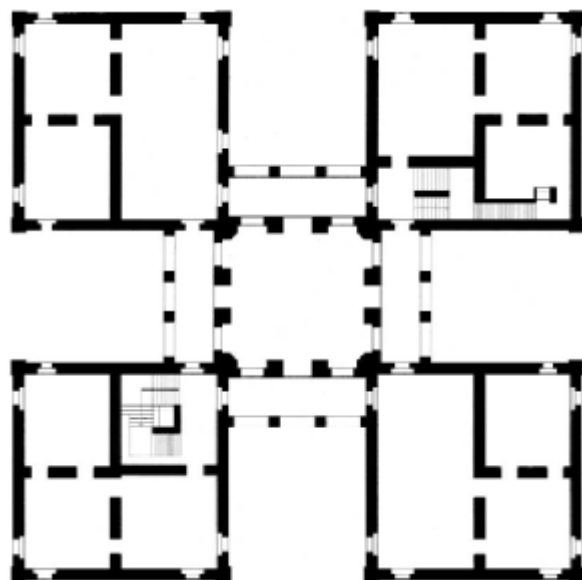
Planimetria della villa di Boffalora. Disegno dall'autore.
